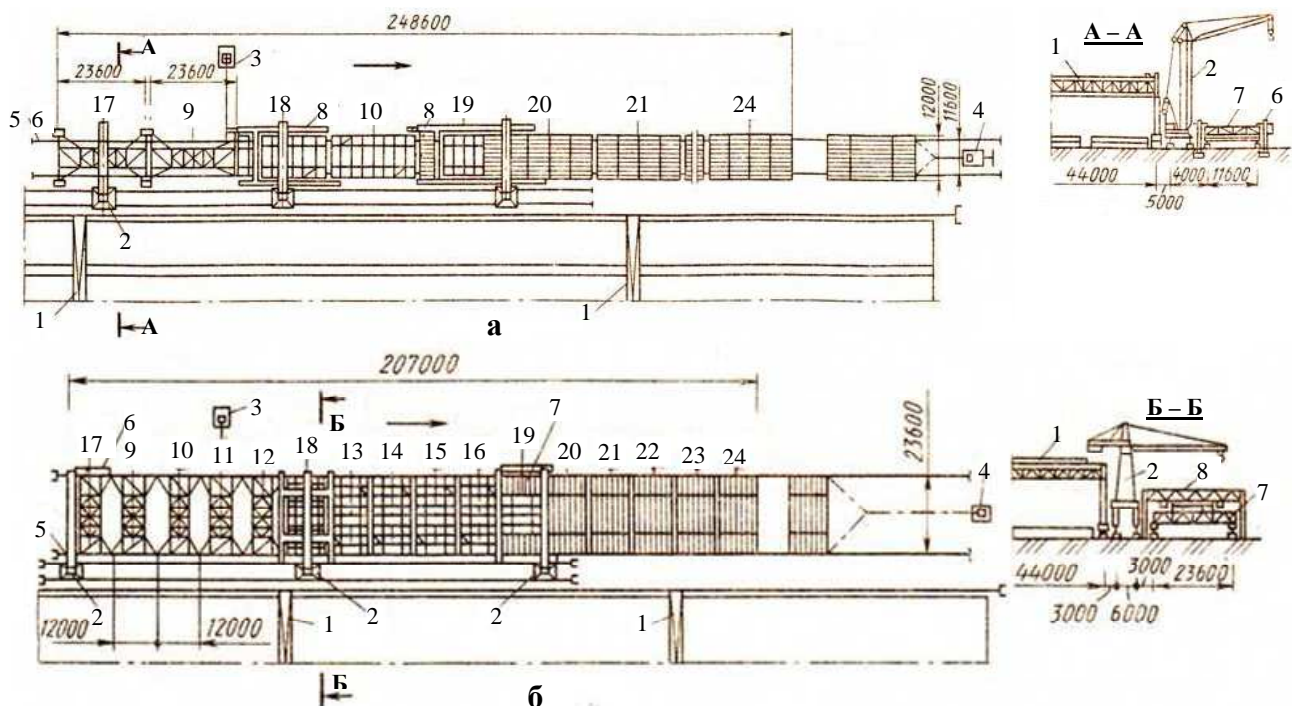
Конвеєрна лінія збільшування плит покриття: а – із поздовжнім розташуванням блоків; б – те саме з поперечним; 1 – козловий кран на складі конструкцій; 2 – баштовий кран під час складання конструкцій; 3 – електрична лебідка для переміщення конвеєра; 4 – те саме для транспортування блоку; 5 – рейкові шляхи; 6 – кондуктор для збирання блоків; 7 – збільшений блок покриття; 8 – стенд-риштування; 9–16 – проміжна стоянка; 17–24 – основна стоянка
